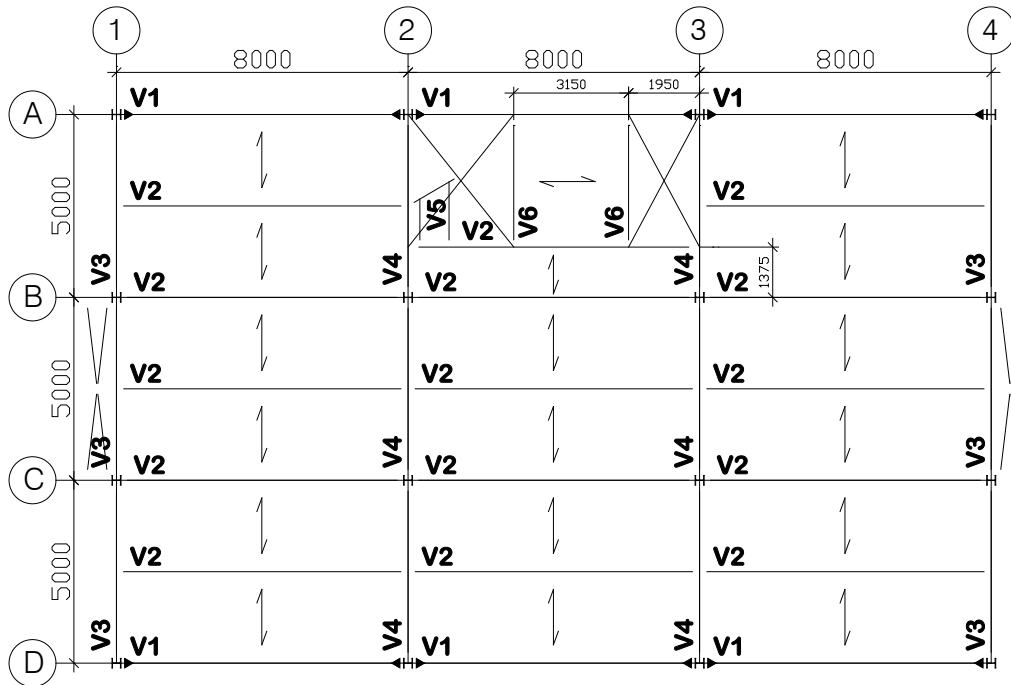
Sistema estrutural do piso e nomenclatura das vigas [3].
